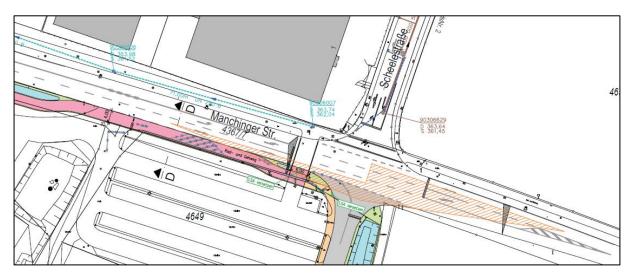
Lageplanausschnitt LSA F10 (K2)
